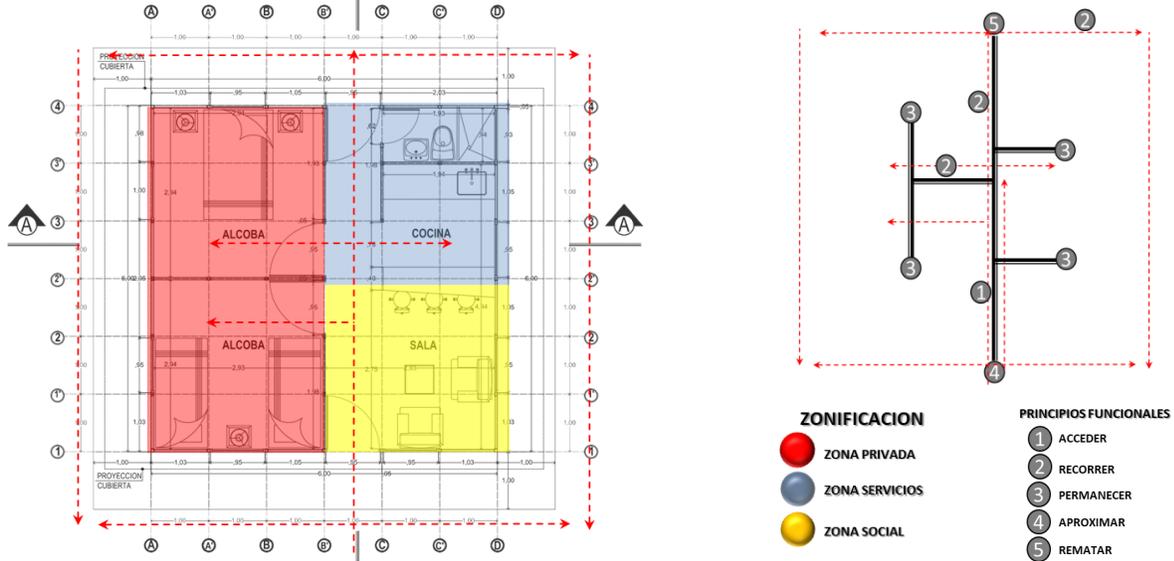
Planta Distribución Vivienda Rural 36m<sup>2</sup>, Fuente: Elaboración Propia.
